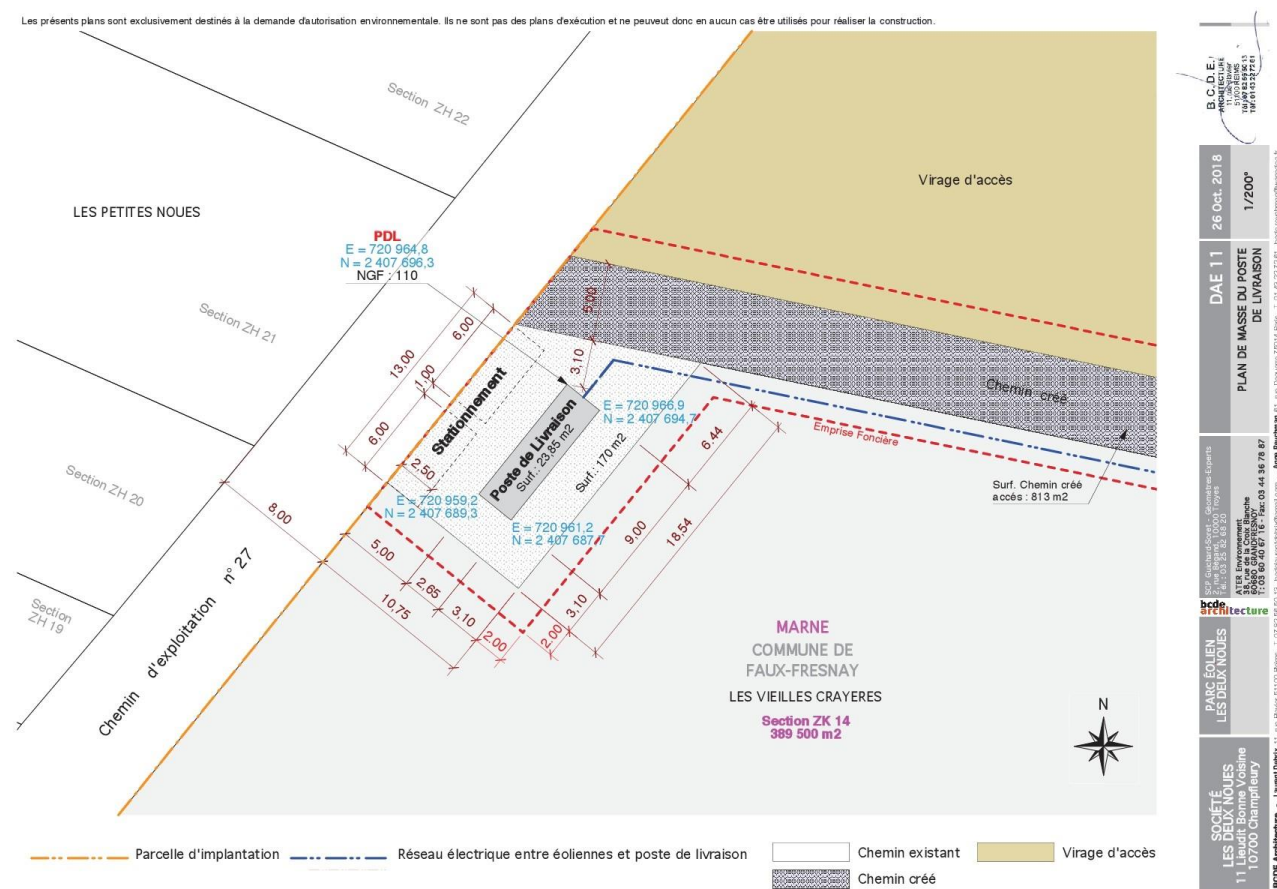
Plans des postes de livraison (source : bcde architecture, 2018)
